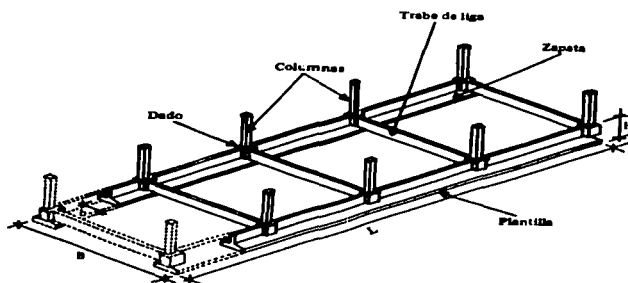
a. Cimentación a base de zapatas corridas en una dirección
